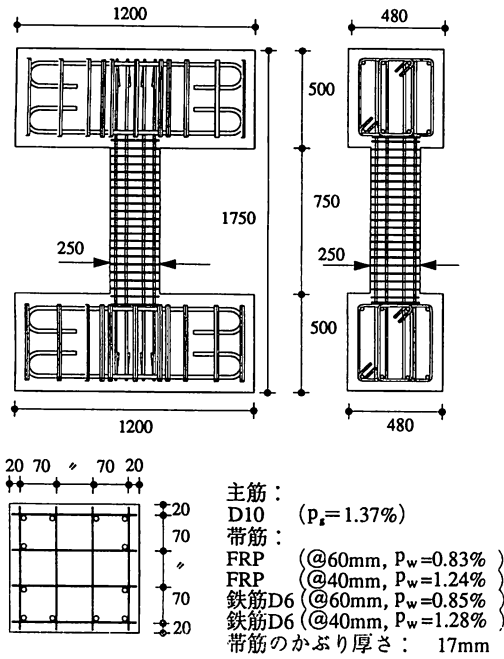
連続繊維補強筋 (FRP筋) を用いた試験体の形状, 寸法, 配筋図
